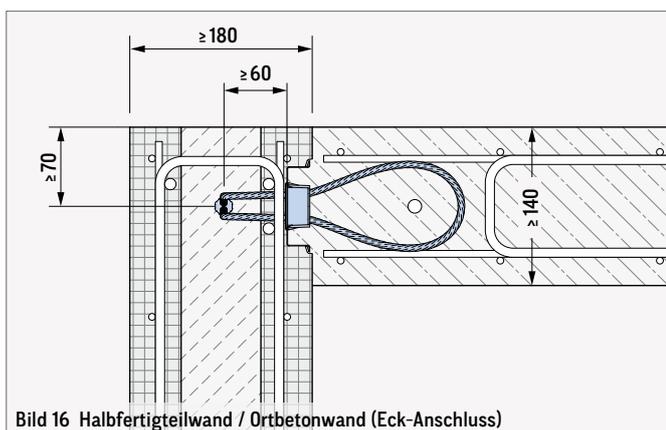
Halbfertigteilwand / Ortbetonwand (Eck-Anschluss)
